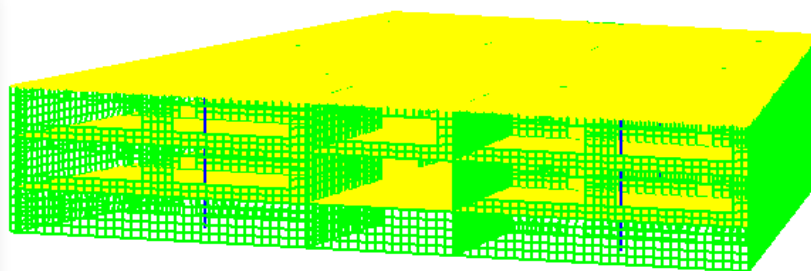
Конструктивные группы железобетонных элементов (группы армирования)
